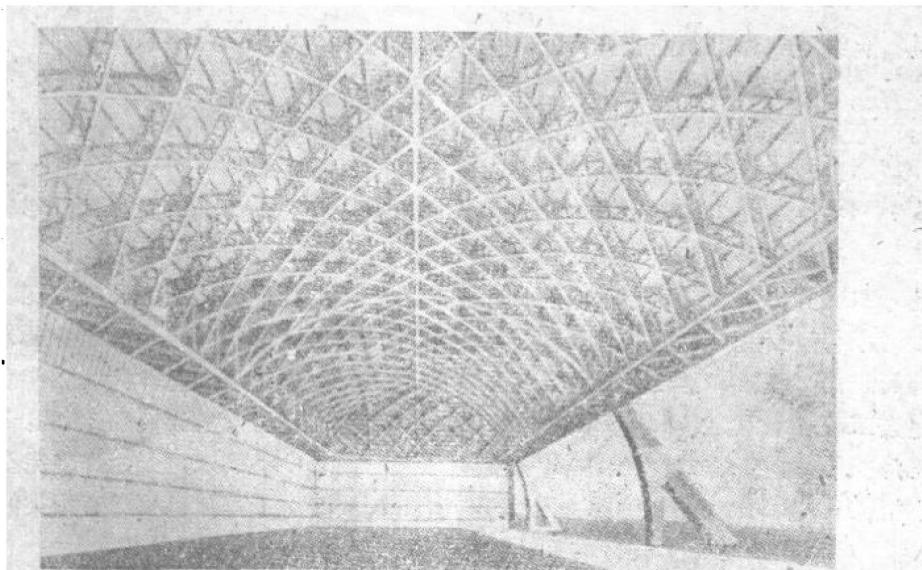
屋盖由装配式钢筋混凝土构件组成的飞机库
